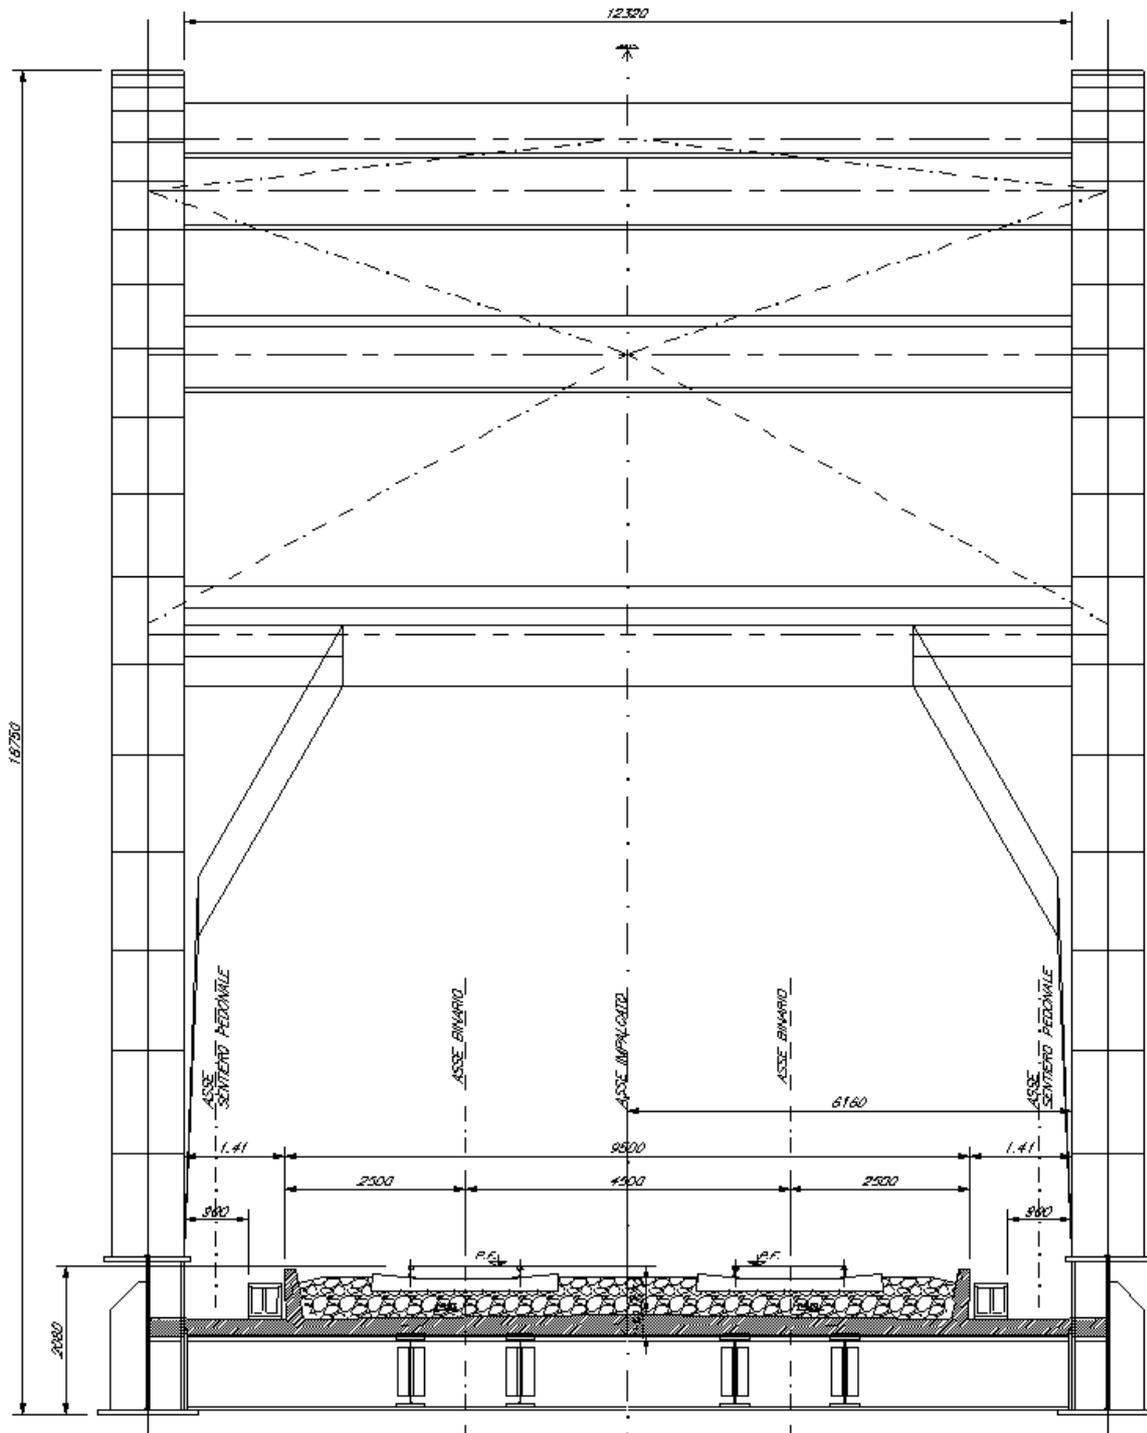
Sezione trasversale impalcato ad arco da 78m
